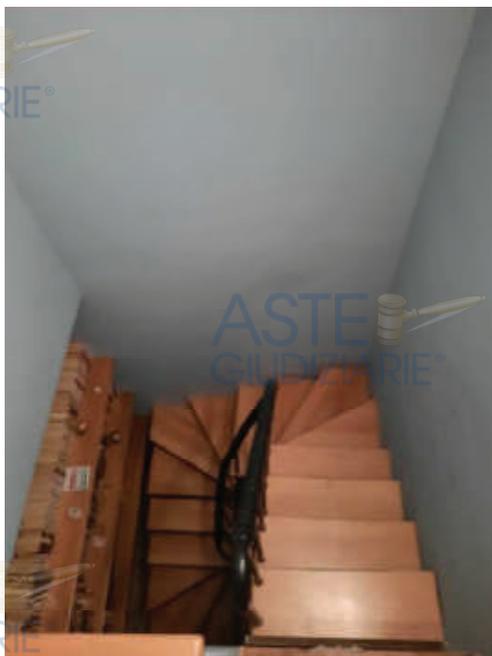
e 34 sub 8 vano scala interno di collegamento tra piano1° e piano 2°
